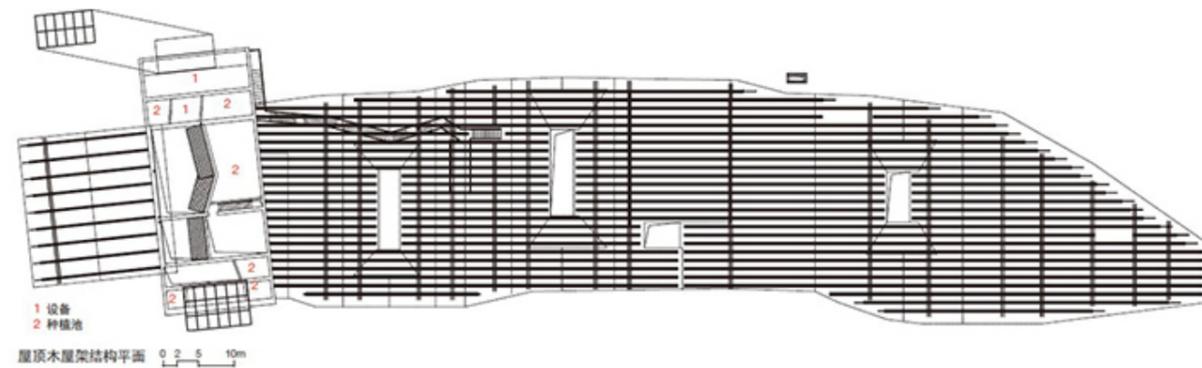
133. Planta de la estructura de la cubierta del proyecto. (Imagen extraída en revista: Journal Architectural 2014 edición 1, página 39).
